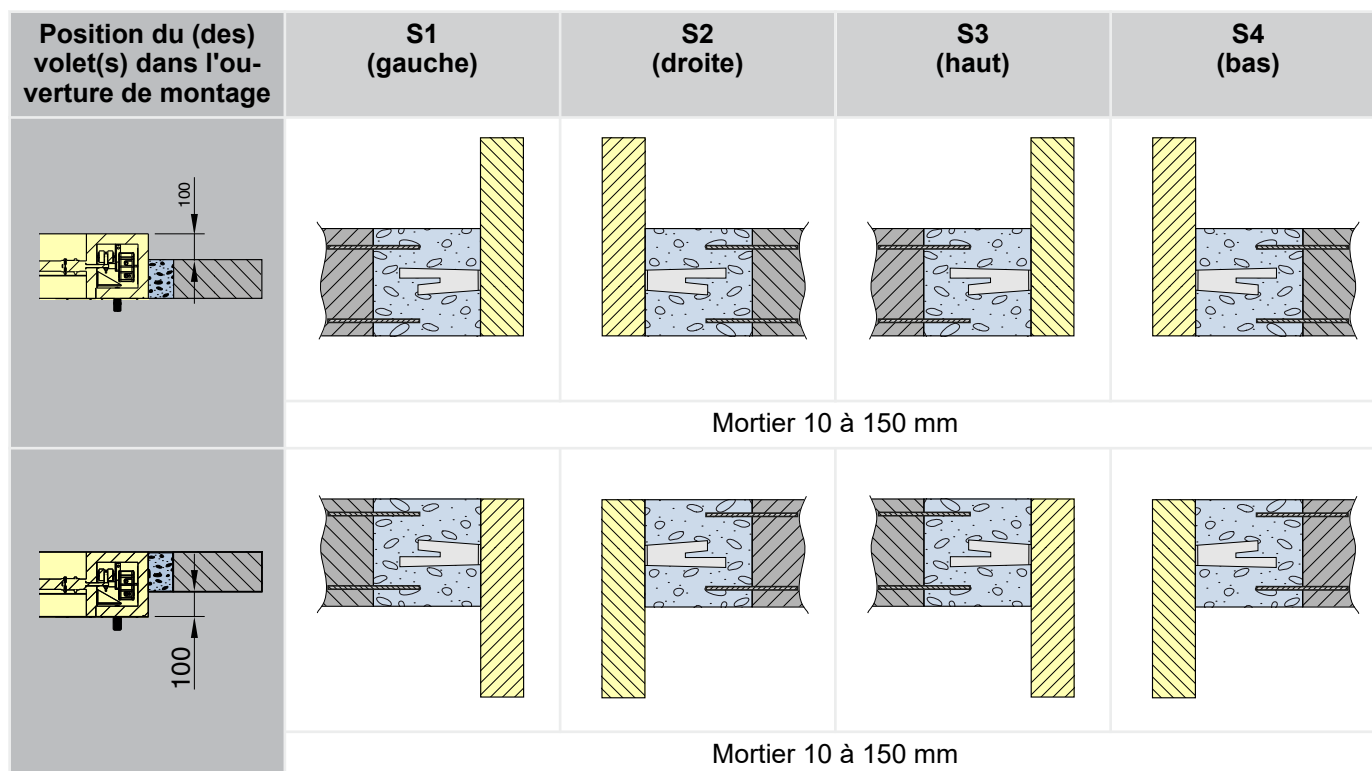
Montage au mortier dans un plafond plein EI 120 S
